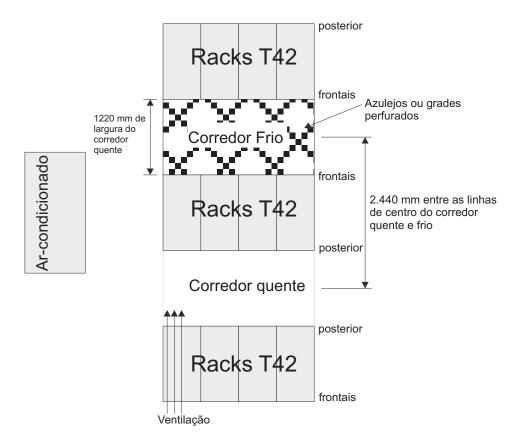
Exemplo de Configuração de Rack com Passagem Fria/Passagem Quente
